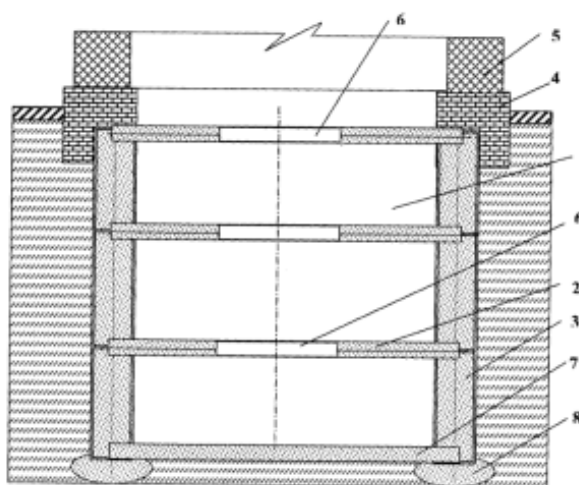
Схема устройства подземного этажа по патенту 34946: 1 – подземное помещение; 2 – перекрытия; 3 – сваи (стена в грунте); 4 – фундамент; 5 – реконструируемое здание; 6 – проем; 7 – плита силового пола подземного этажа; 8 – опорная подушка
